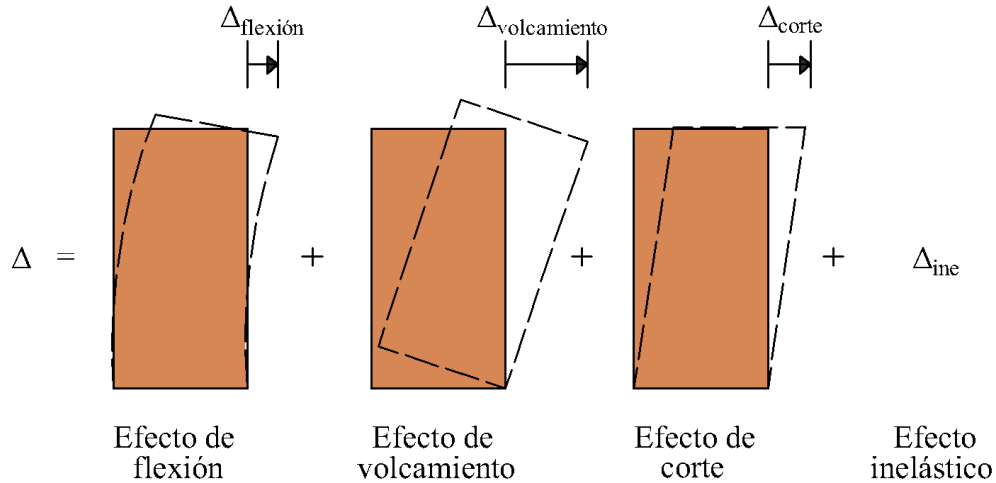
Efectos de deformación de muro de corte revestido con placa estructural de madera.
